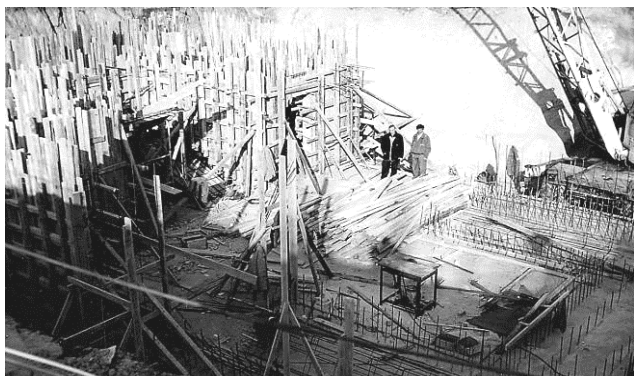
Опалубка для залізобетонних стін підземної частини дзвіниці
